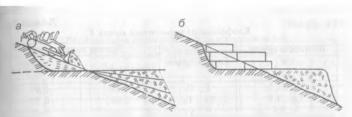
Схема разработки бульдозером террас и полок на косогорах: а – поперечными; 6 – продольными проходами.
